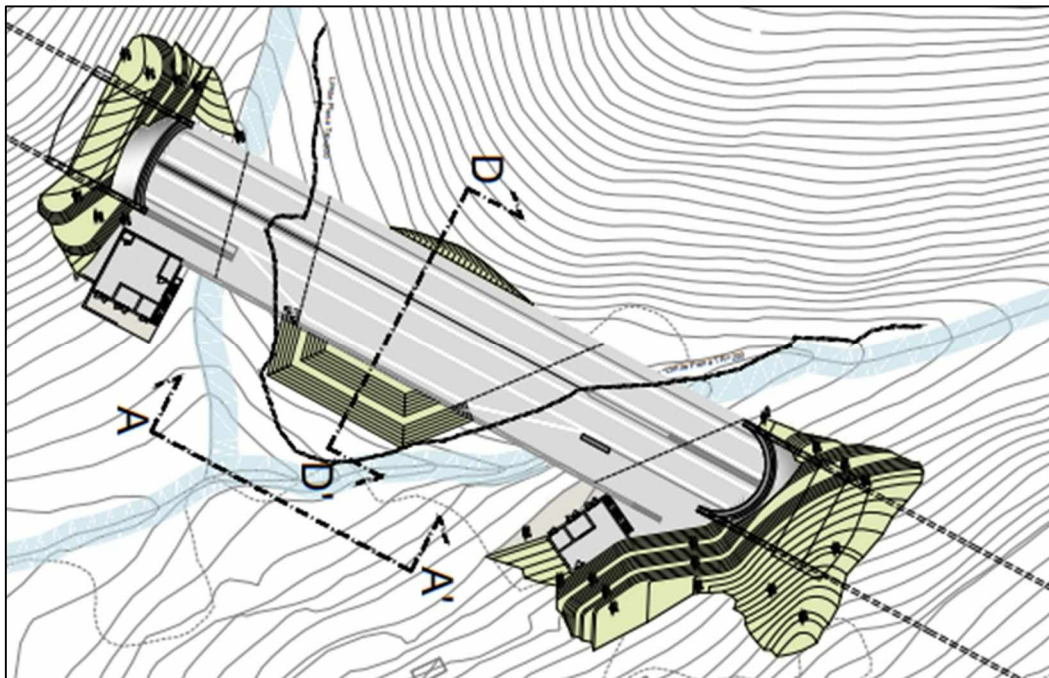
Stralcio planimetrico sulla Finestra di Arboccò
